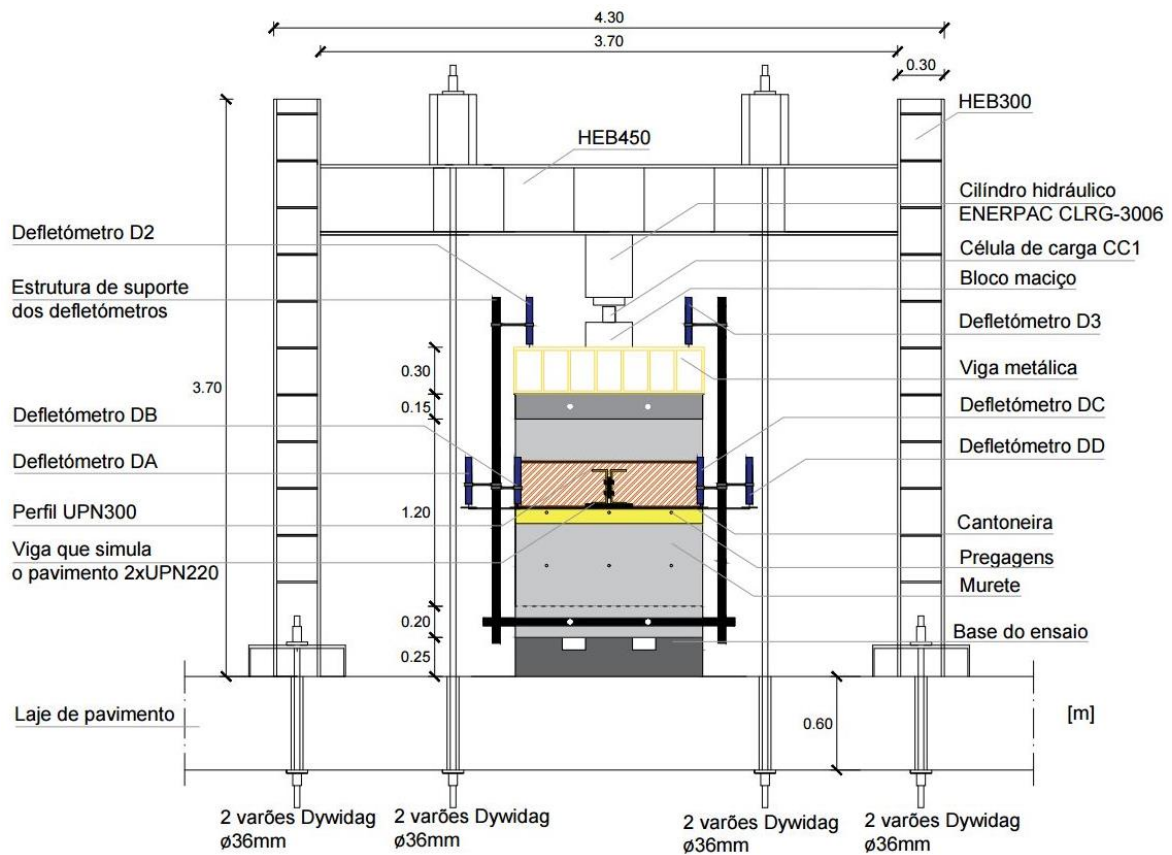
Sistema de ensaio de compressão axial do murete (adaptado para o ensaio da ligação pavimento/parede)
